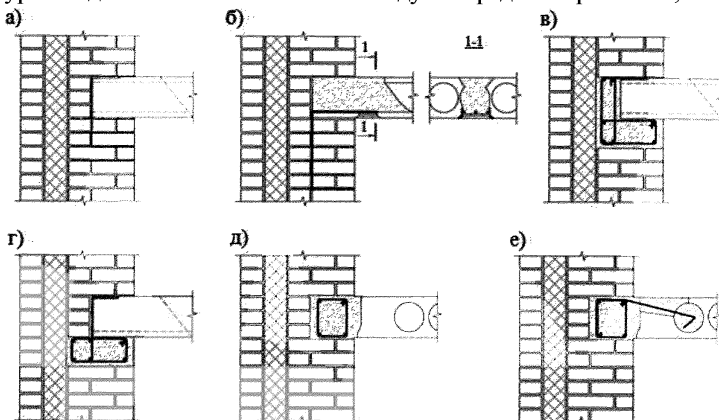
Варианты устройства армированных поясов и анкеровки плит перекрытия:
